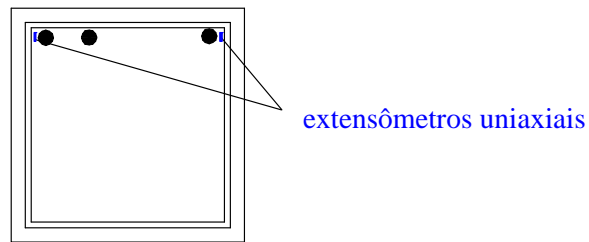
Posicionamento dos extensômetros na armadura de flexão do consolo.
